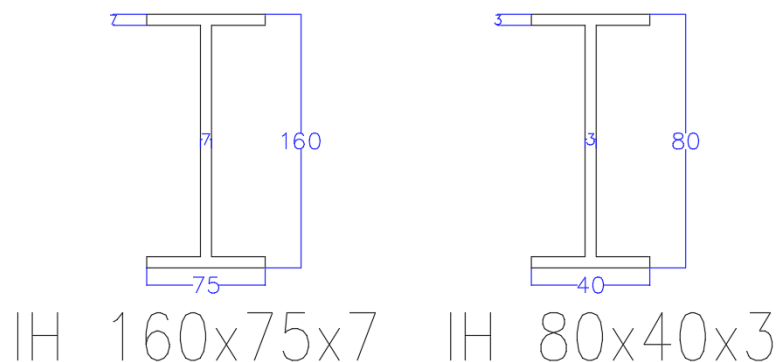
Perfiles de vigas principales (izquierda) y vigas secundarias (derecha)
